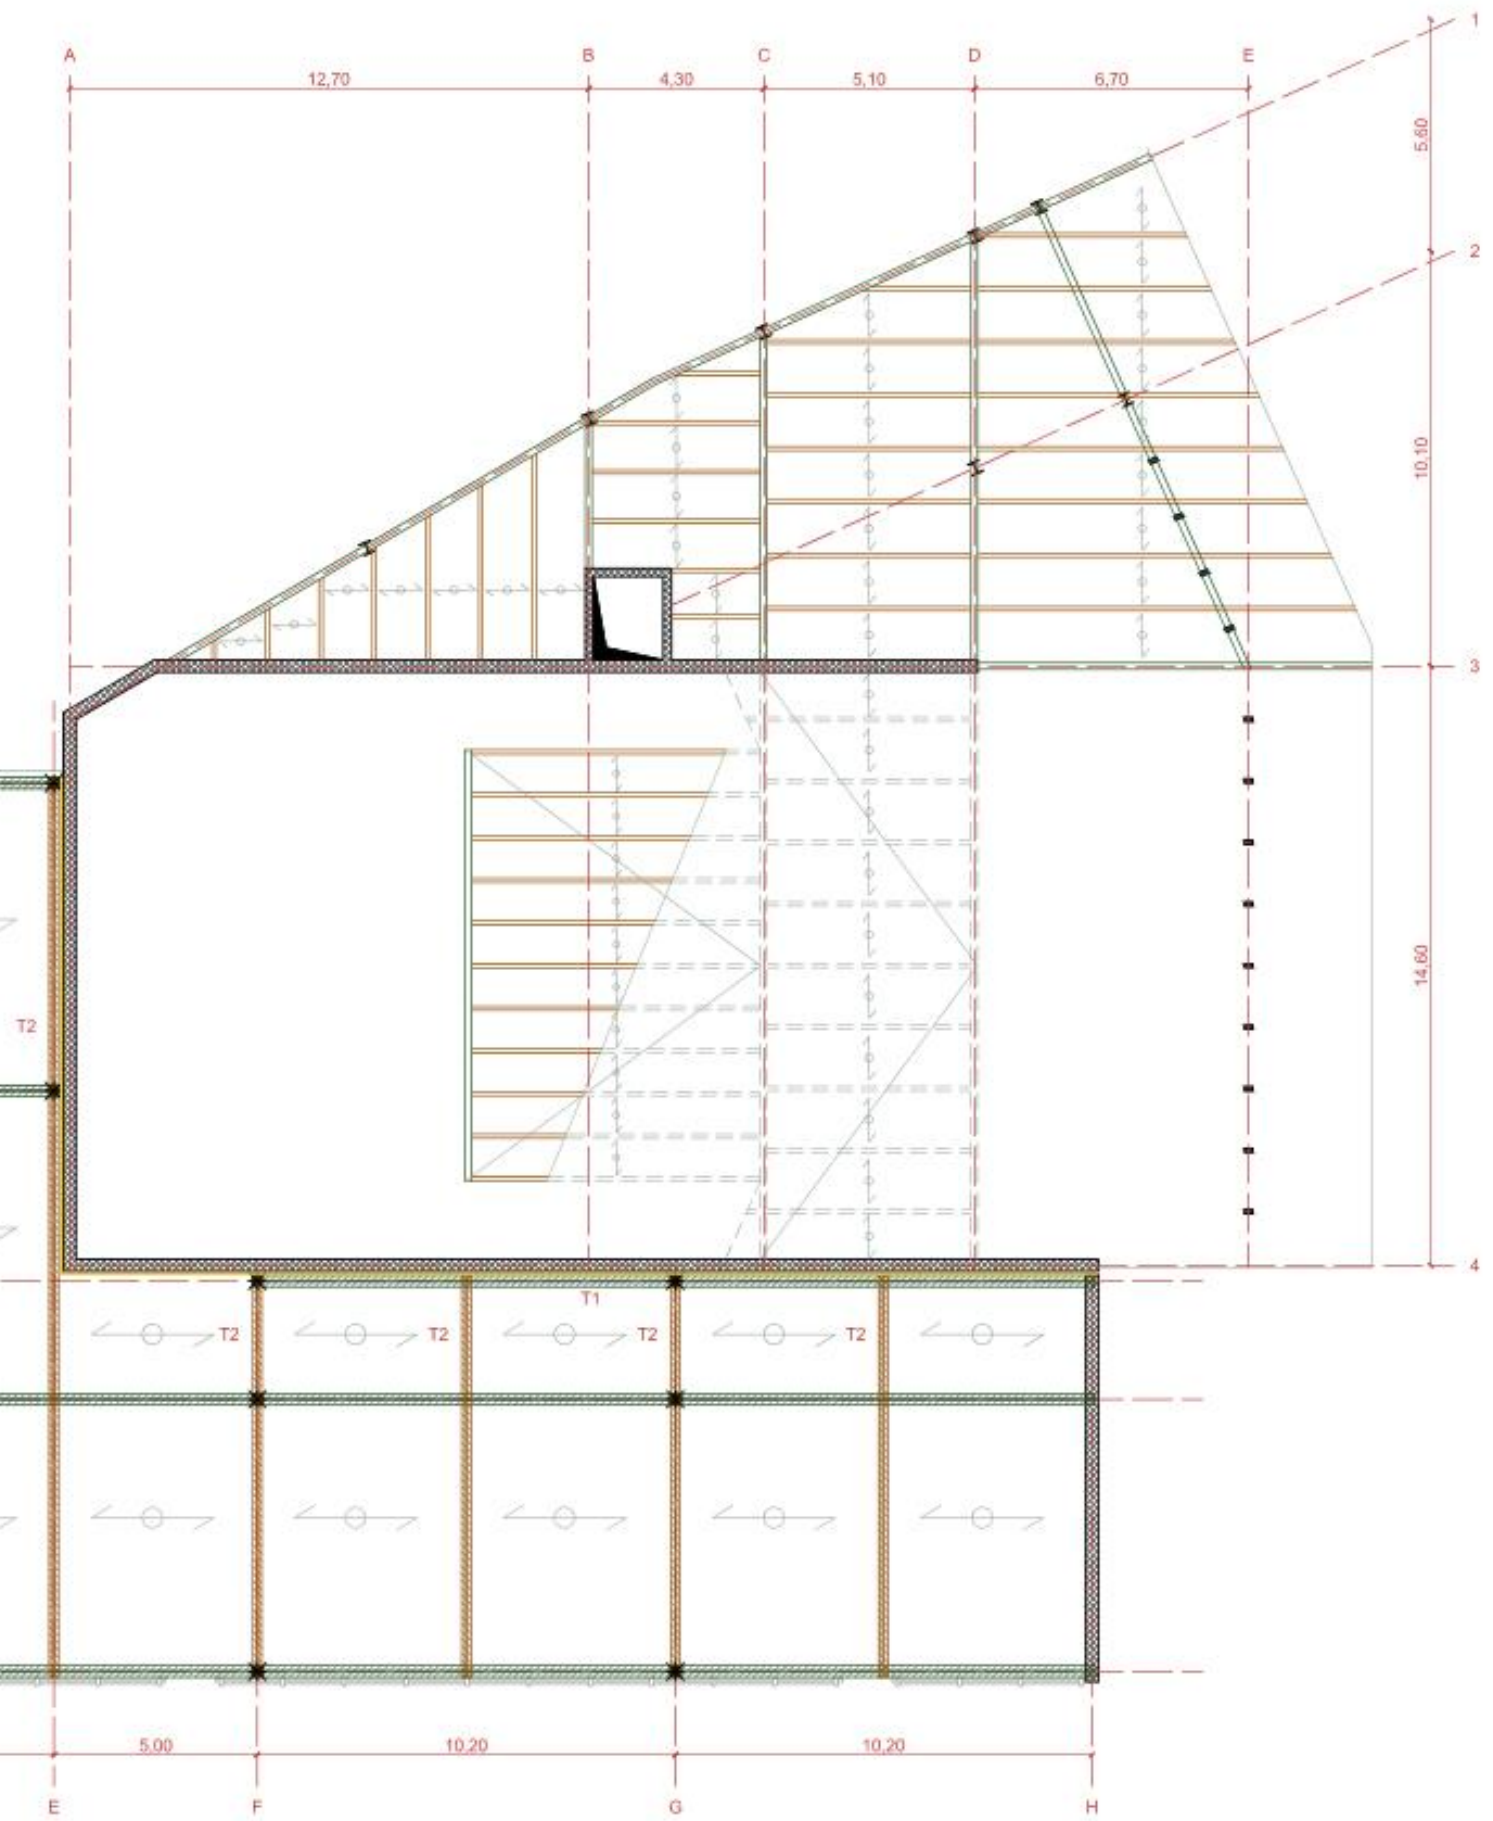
Pianta solaio piano primo edificio auditorium
